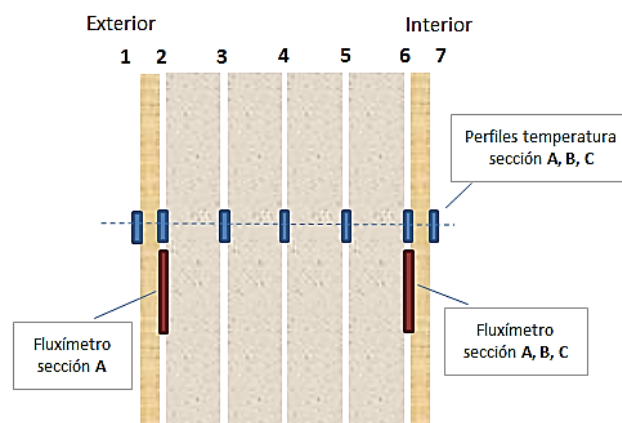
Esquema de instalación de sondas en el primer componente
